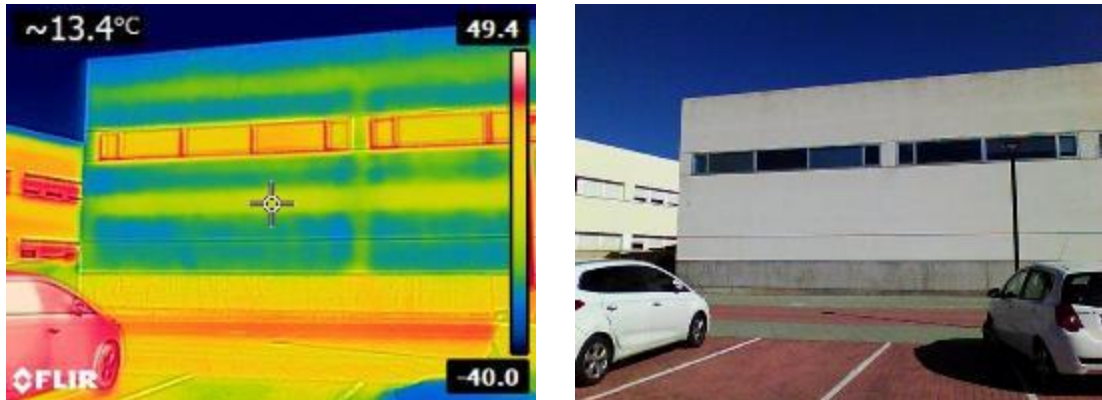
Termografía e imagen exterior de la fase 2 donde se aprecia el puente térmico de la estructura.
